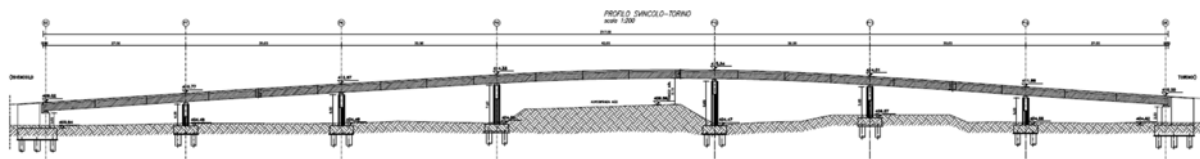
Sovrappasso di ingresso - profilo longitudinale
